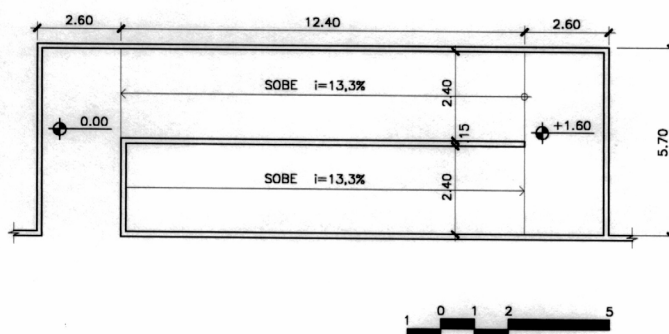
Planta da rampa que interliga os pavimentos térreo, 1º e 2º - rampa 2 – Escola B
